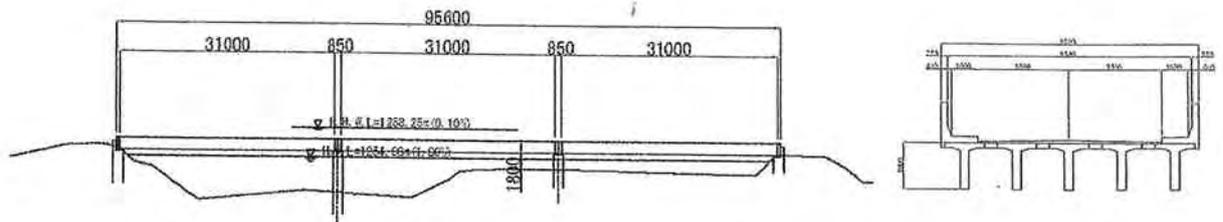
Plan du Pont à poutres en T simple avec système de précontrainte par tension après bétonnage (post-tension, longueur de travée : 31,0 m)
